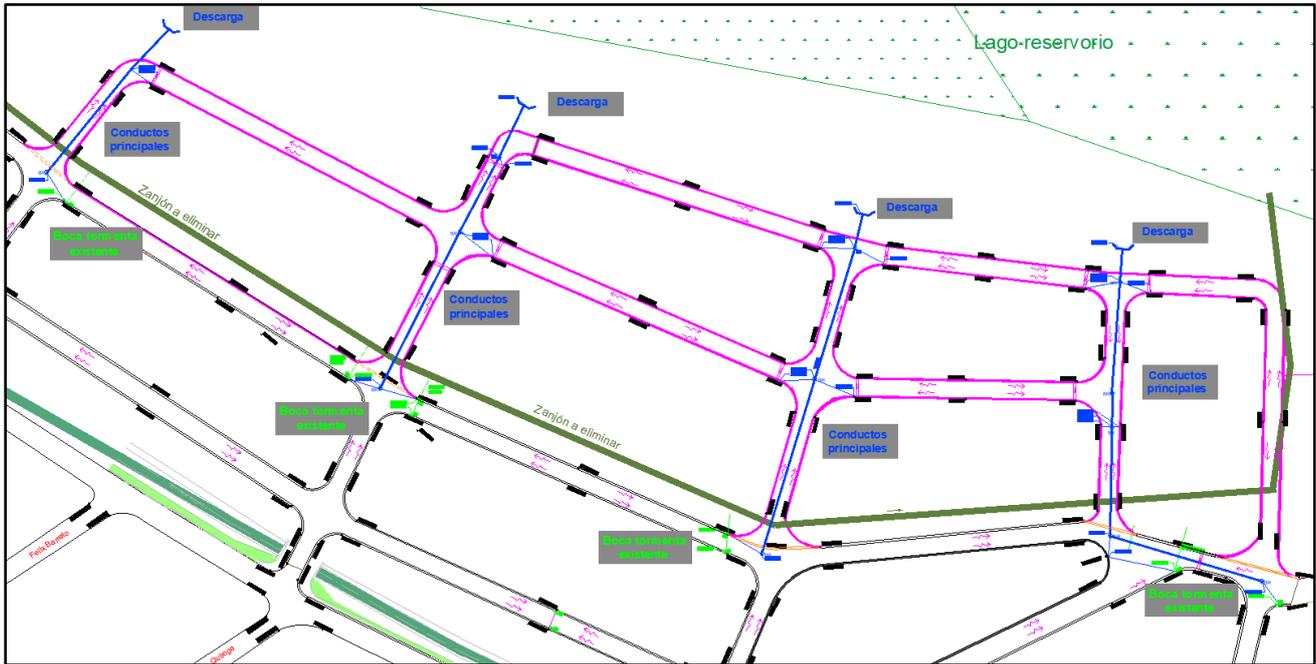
Esquema del sistema de drenajes propuesto para el barrio.
